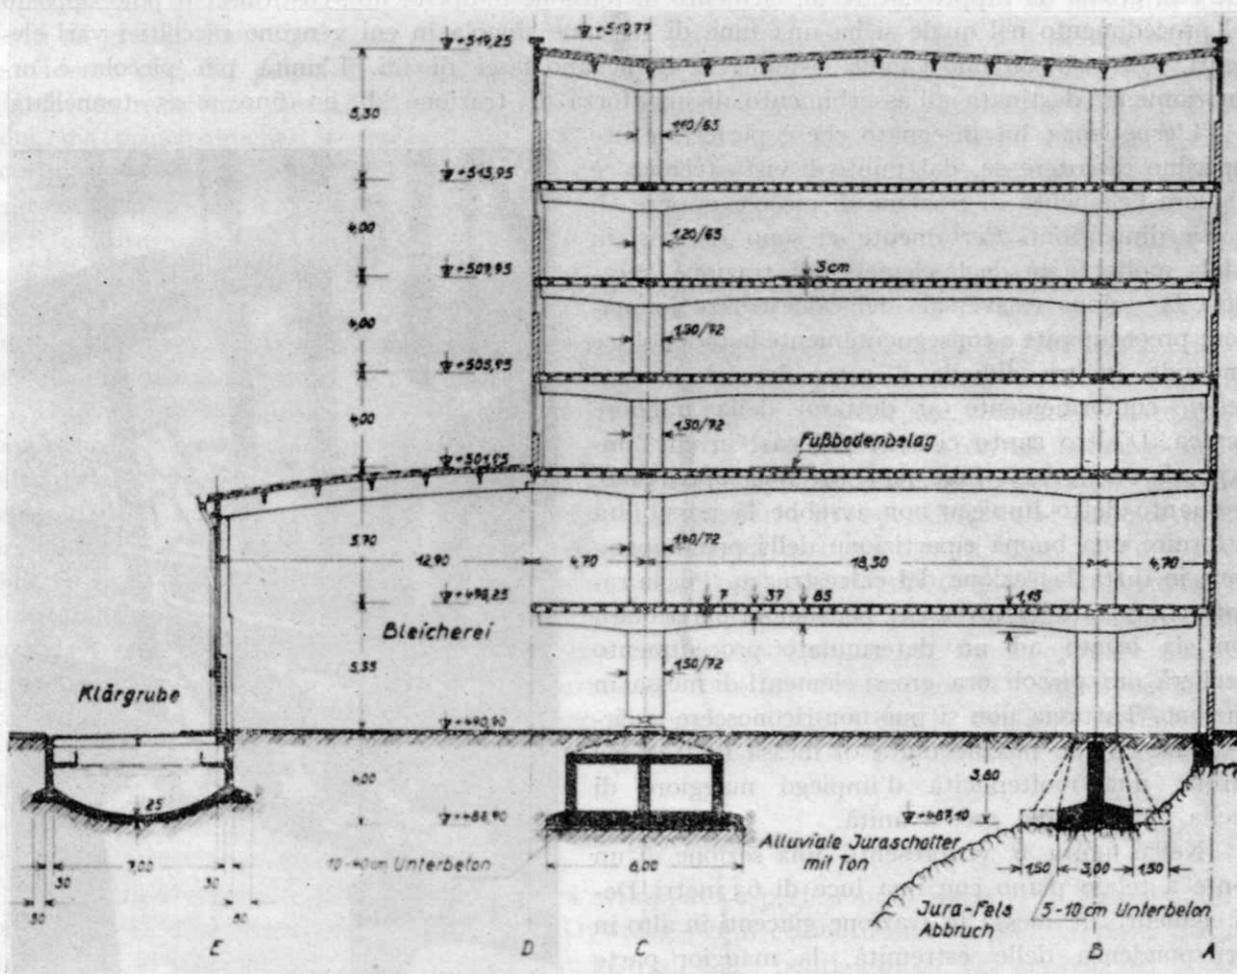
Edificio della Wuerttembergische Kattunmanufaktur, Heidenheim (Brenz) - Sezione trasversale.
